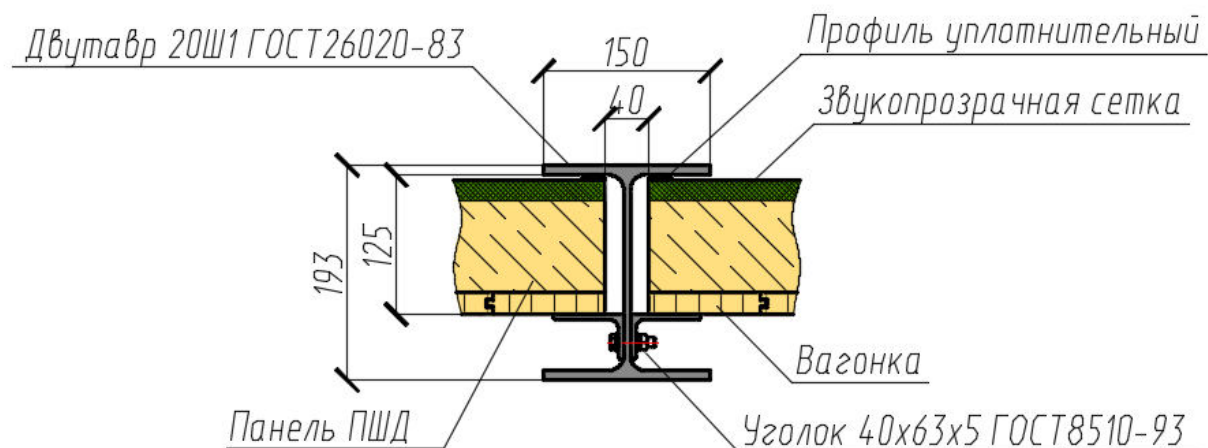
Установка панелей ПШД с перекрытием вагонкой вертикальных несущих элементов
